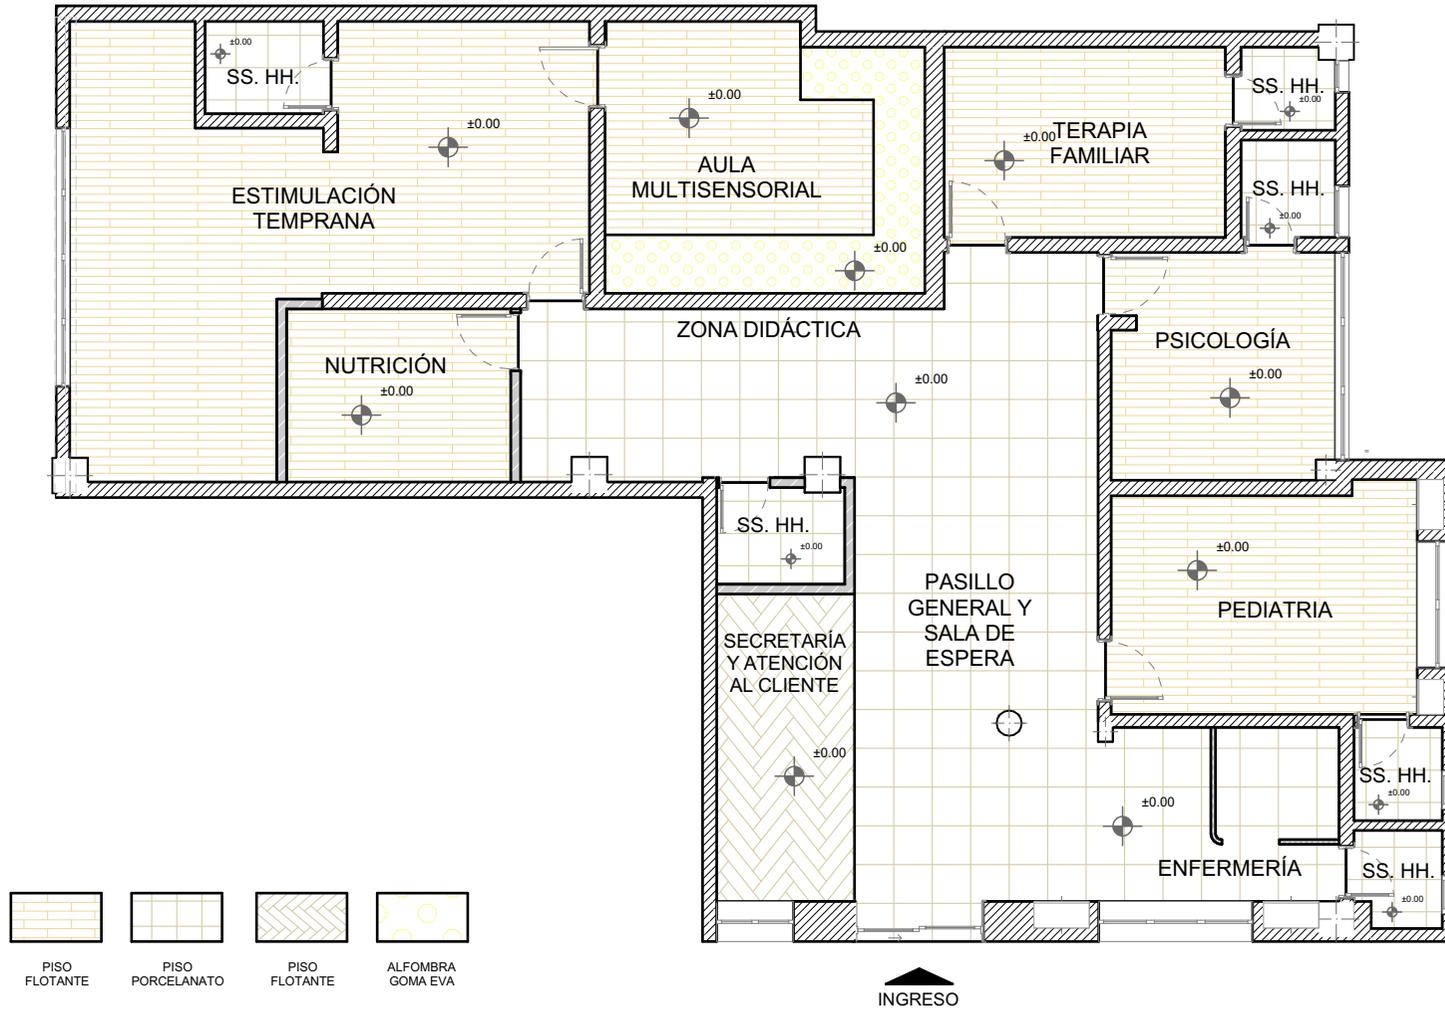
Planta de pisos propuesta CEDIUC Fuente: Propia
